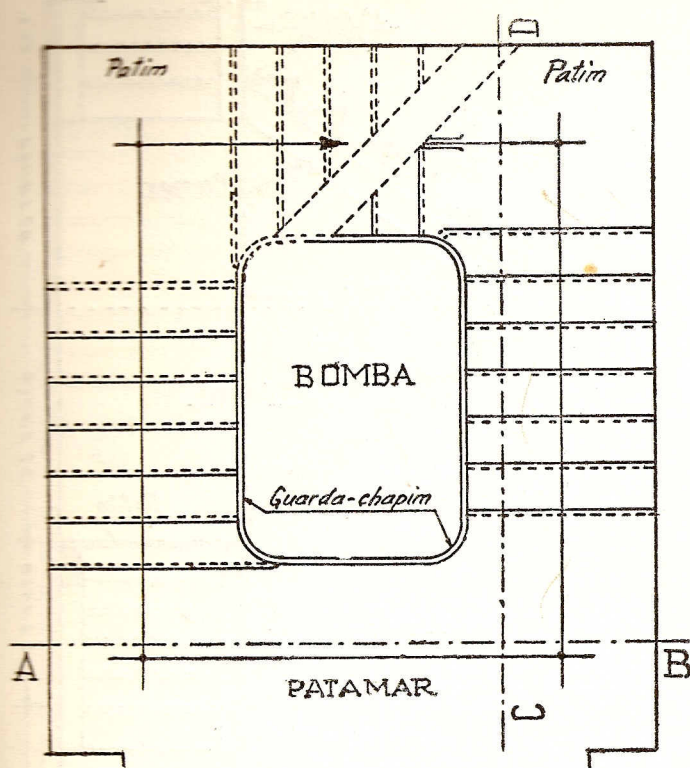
PLANTA DA ESCADA NOS ANDARES
